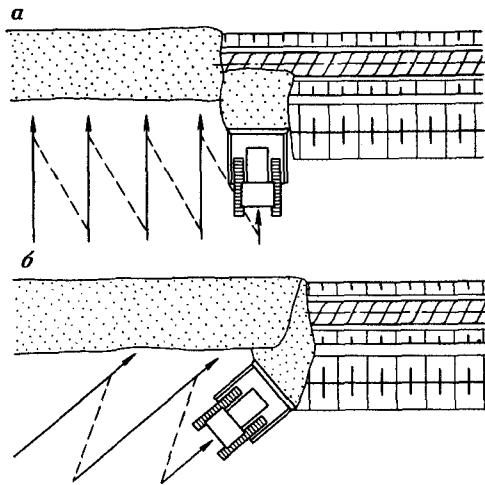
Схема засыпки траншей прямолинейными (а) и косопоперечными (б) проходами бульдозера
